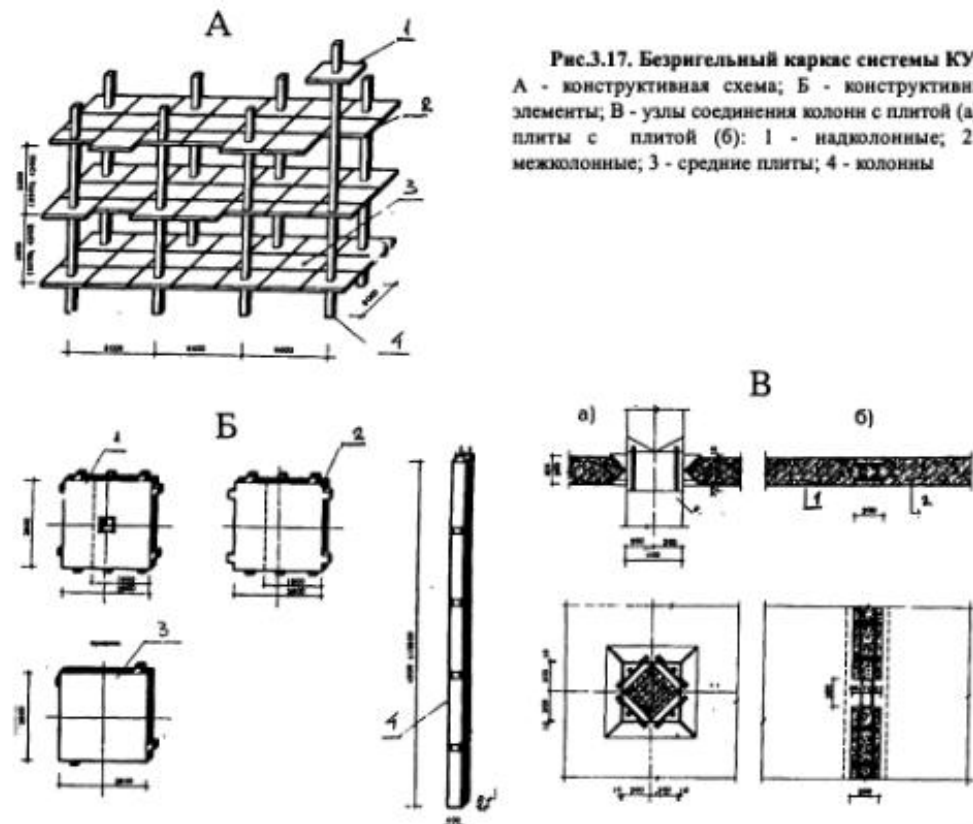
Безригельный каркас системы КУБ: А - конструктивная схема; Б - конструктивные элементы; В - узлы соединения колонны с плитой (а) и плиты с плитой (б): 1 - надколонные; 2 - межколонные; 3 - средние плиты; 4 - колонны
